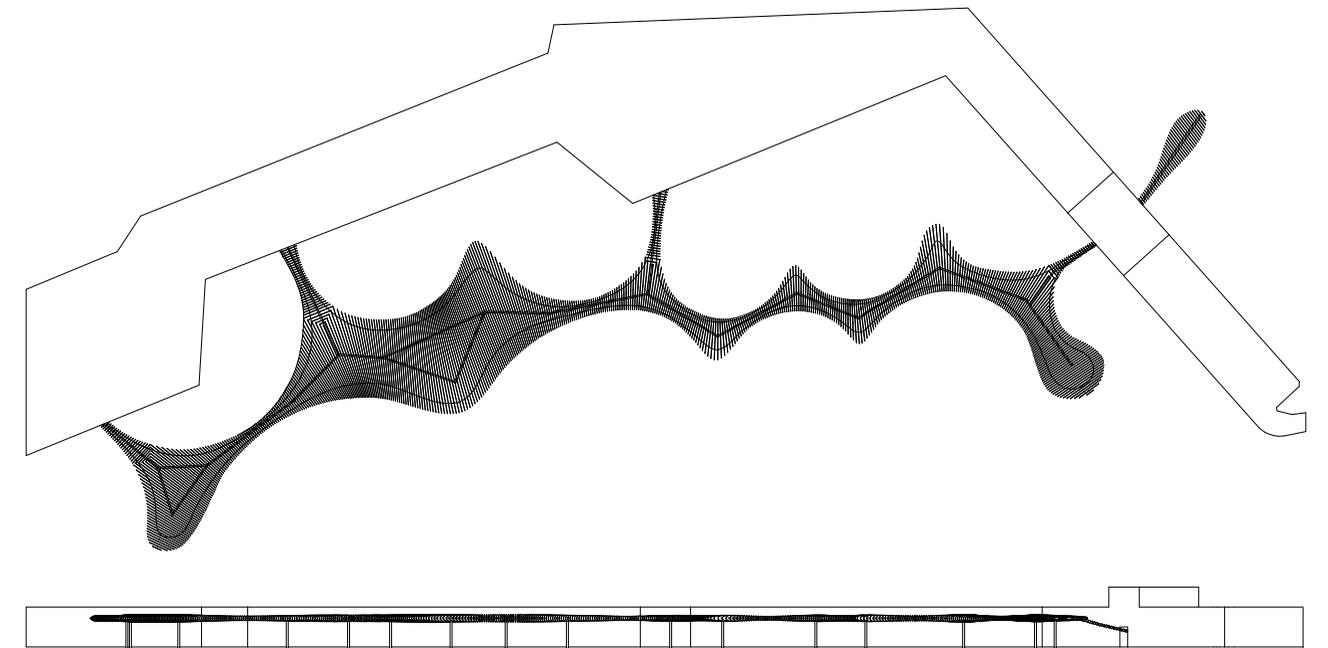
Grundriss und Schnitt der Überdachung
